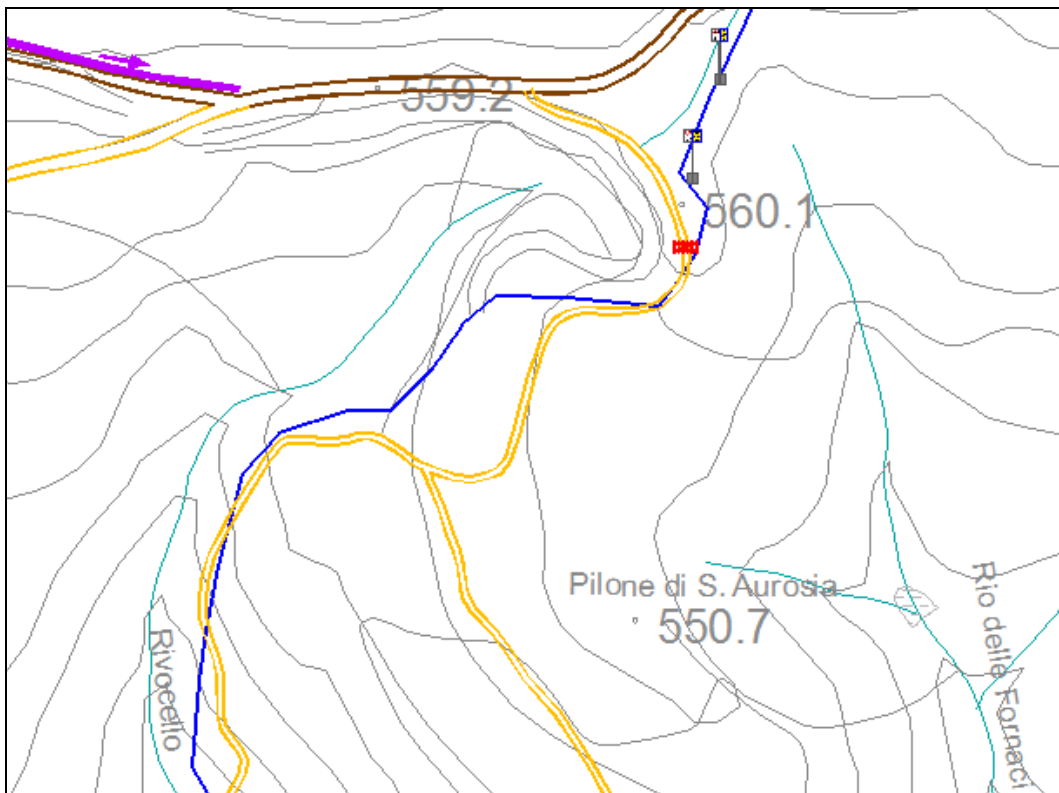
Localizzazione cancello sulla strada che sale verso il Pilone di S. Aurosia (cfr. elaborato C2 - Planimetria generale di progetto)
